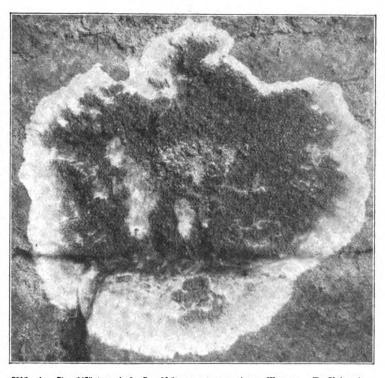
Fruchtförper bes hausschwamms an einer Mauer. Berkleinert.
